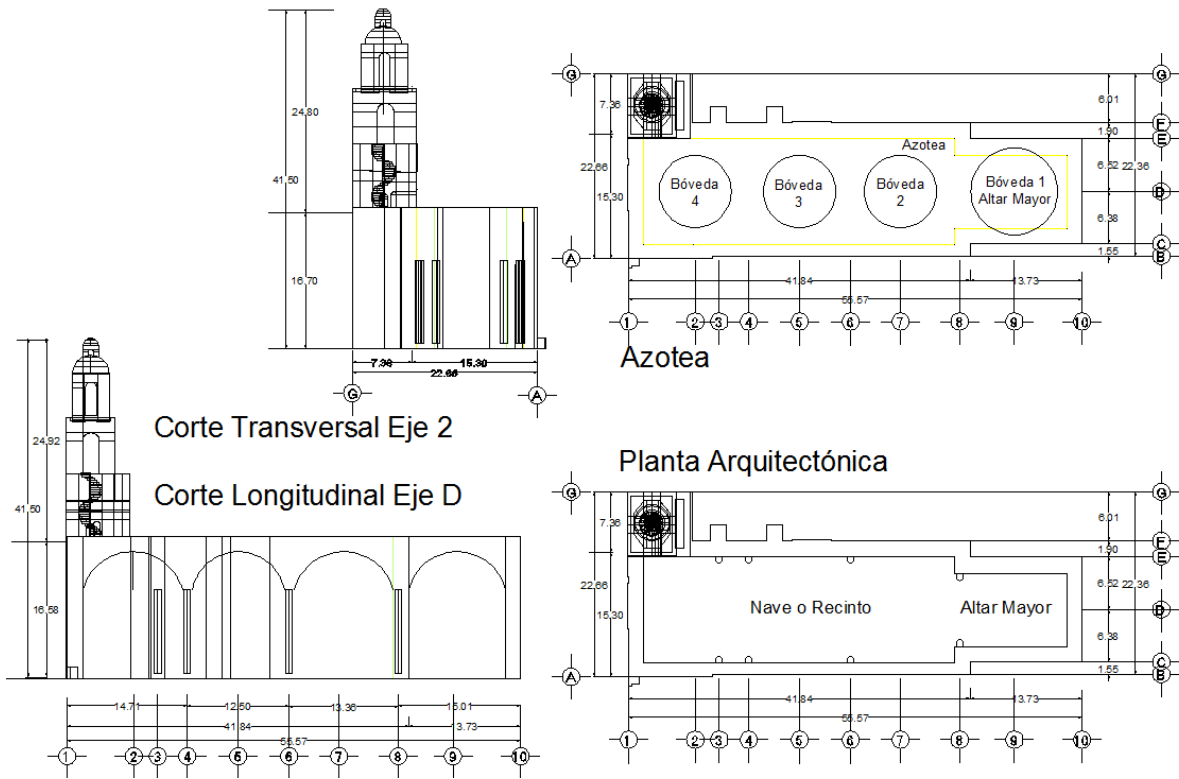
Planta Arquitectónica, Azotea, Cortes Longitudinal y Transversal
